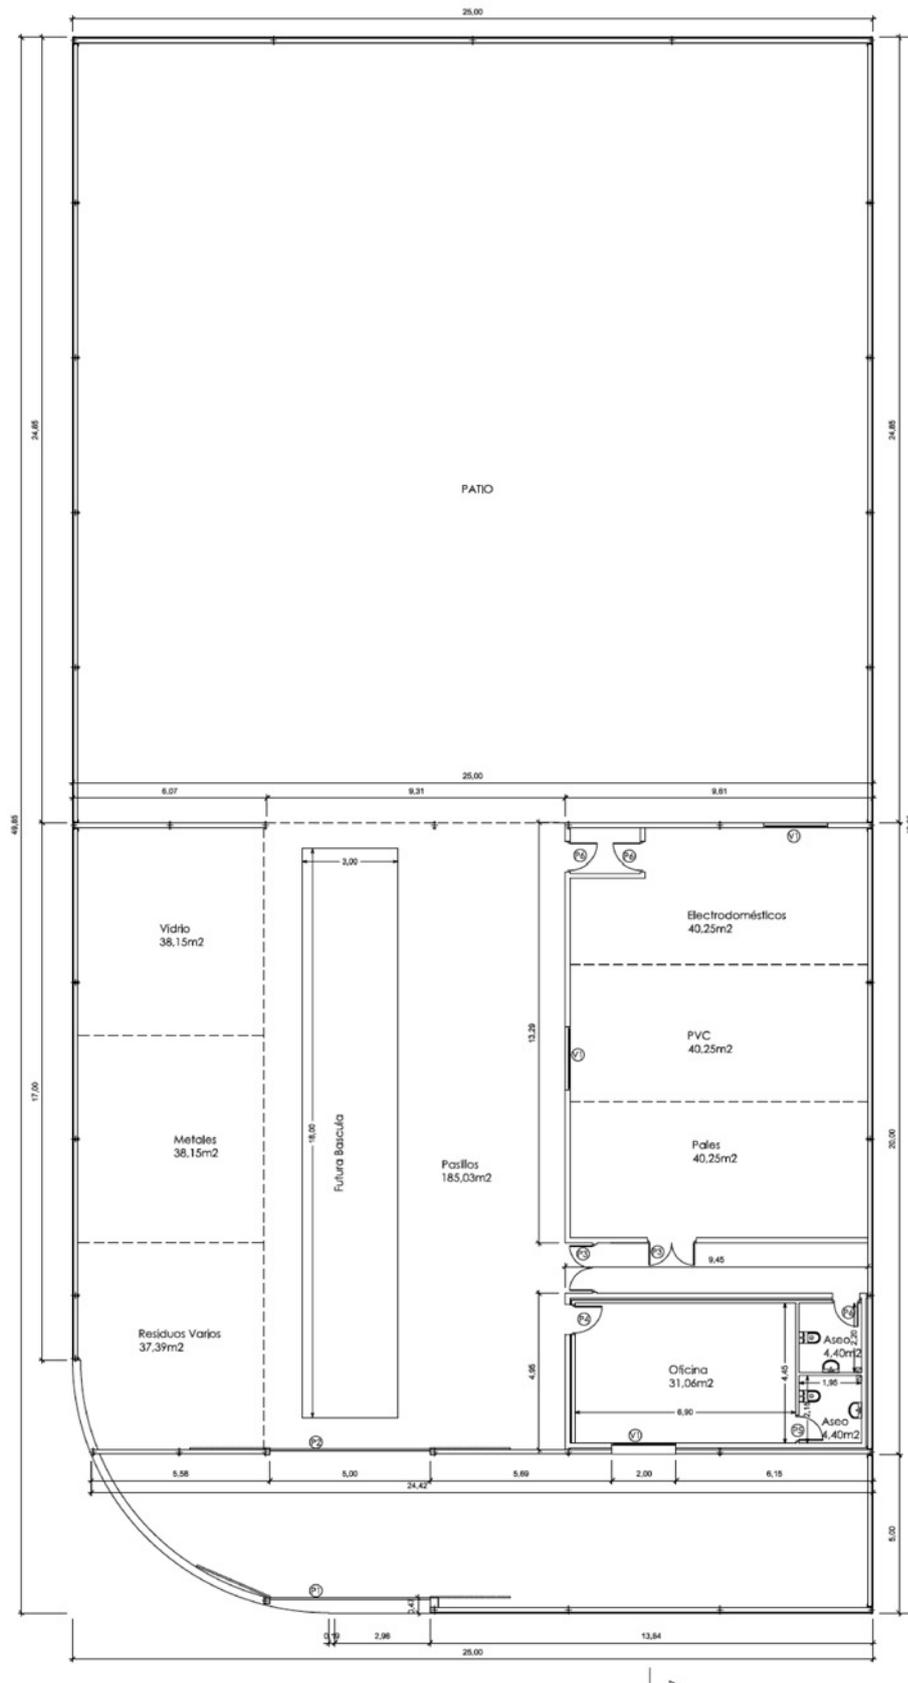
Plano en planta de la instalación en el que se muestran usos y superficies.
